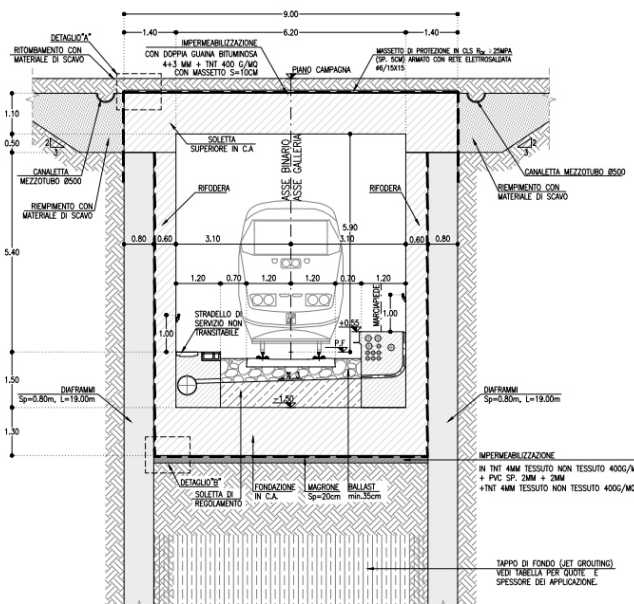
Sezione Galleria GA04B e GA04C tratto su diaframmi
